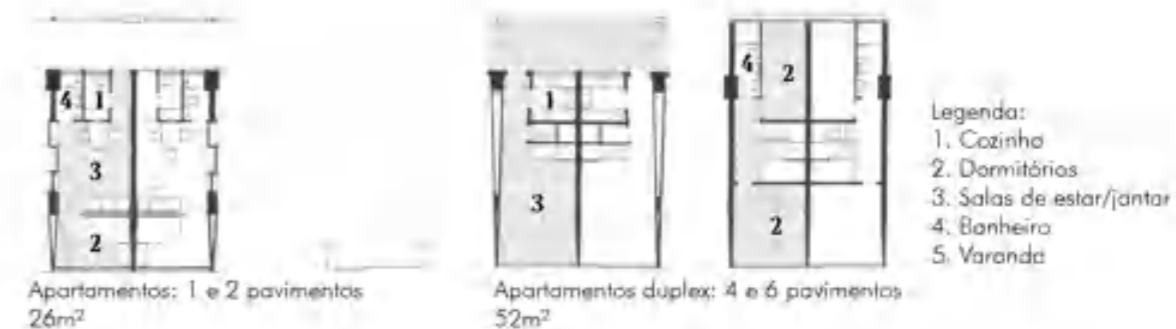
Plantas baixas dos tipos de unidades habitacionais encontradas no bloco principal do conjunto.
